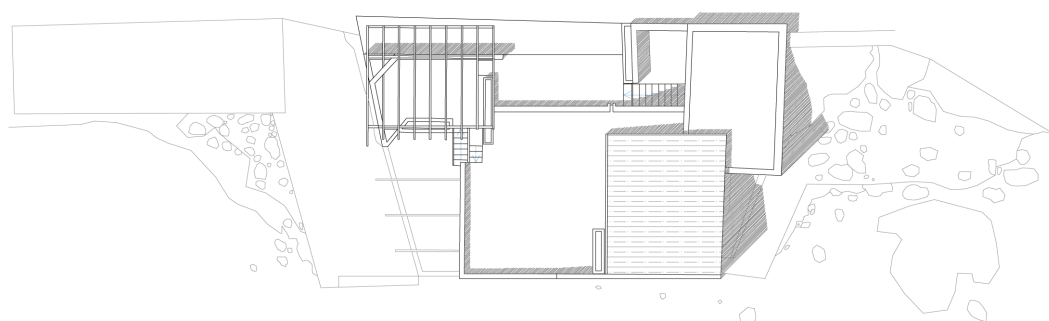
Refúgio "La Roiba": Planta de coberturas
